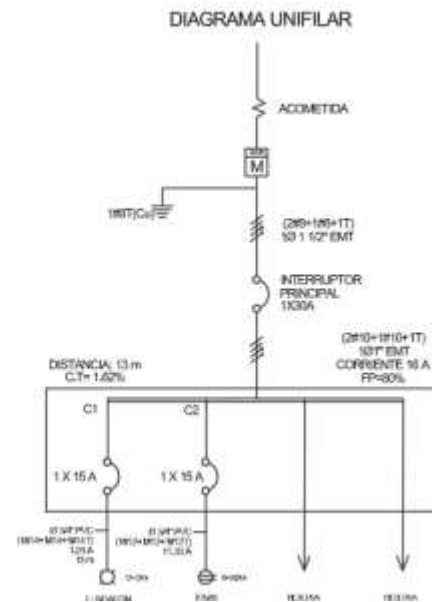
, Planta unifilar, 2025-II, Edwin Castro.
